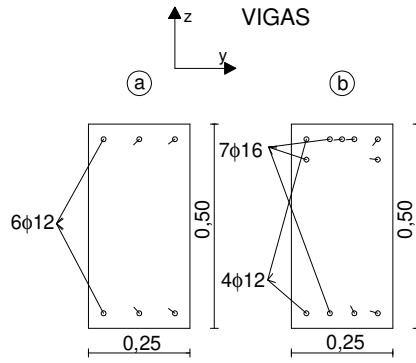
Secções das vigas do pórtico de 4 pisos
